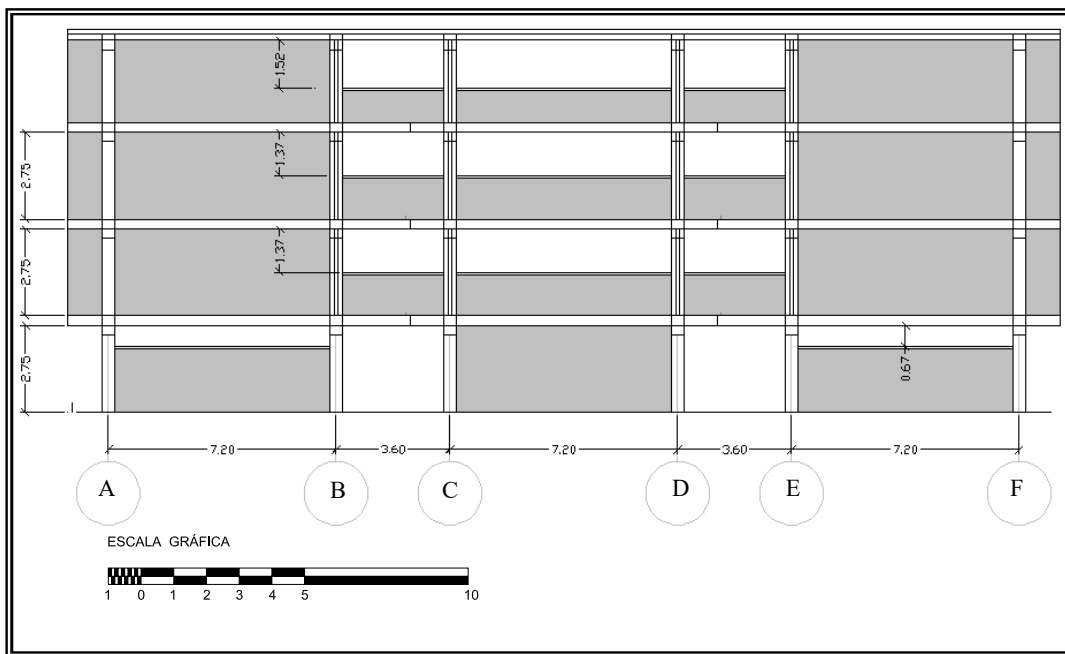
Pórtico 4 (norte-sur) mostrando las paredes de mampostería y la longitud efectiva de columnas
